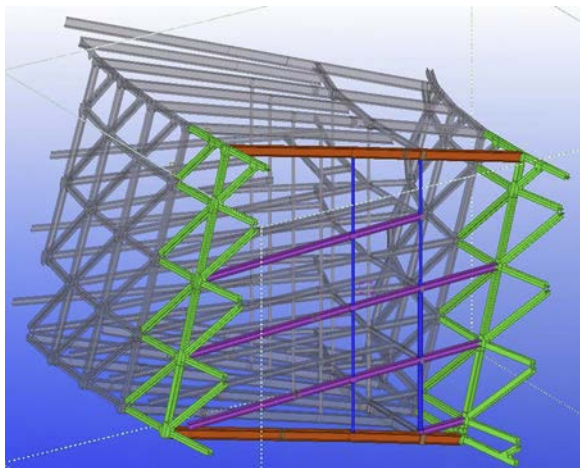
Sección a lo largo de un plano radial del modelo 3D de la estructura metálica. La sección cajón formada por las celosías de fachada (en verde en el dibujo) y los forjados de fondo y cubierta (vigas en naranja) se encuentra rigidizada por los diafragmas formados por las vigas de planta (violeta) y los soportes tubulares interiores (azul).
